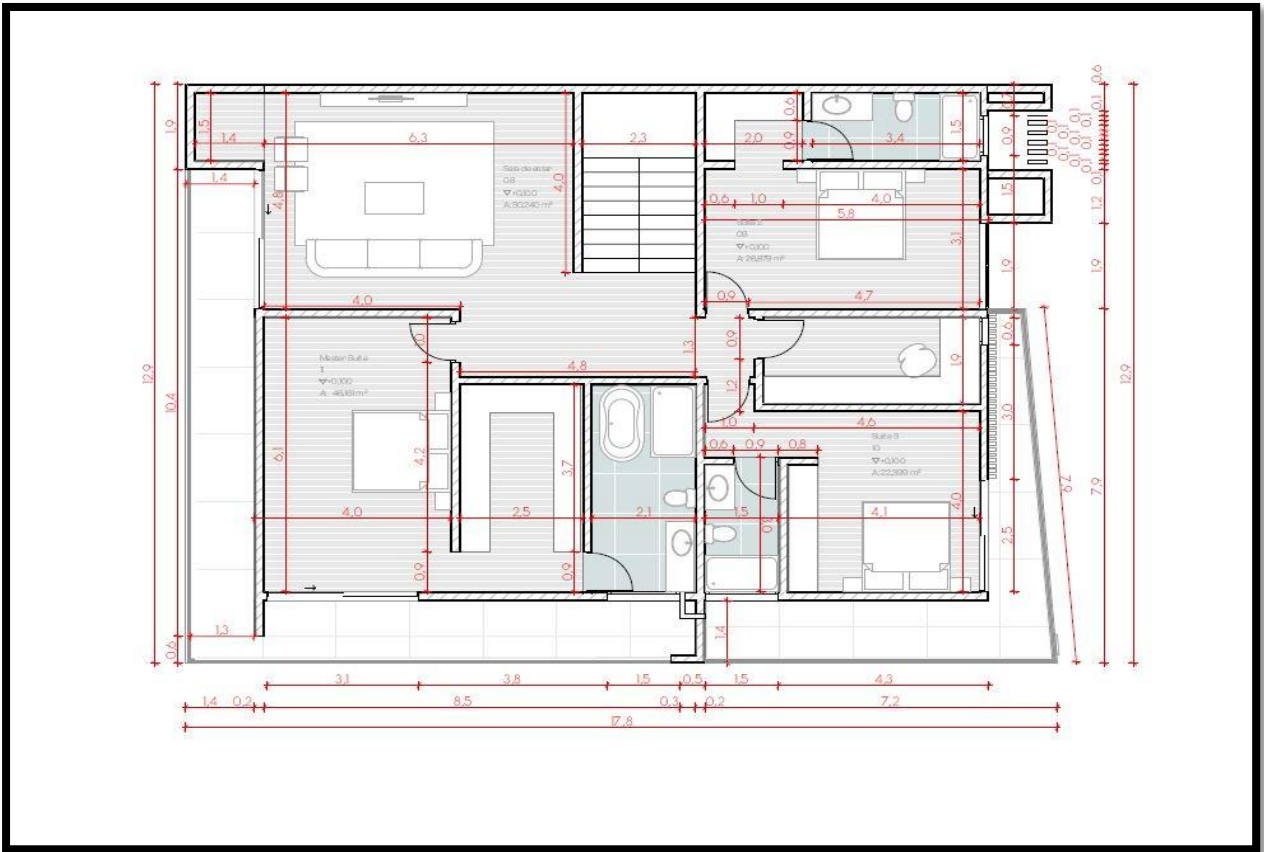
Planta do Primeiro andar. (fonte: Golfo Engenharia e Construções, SA)
